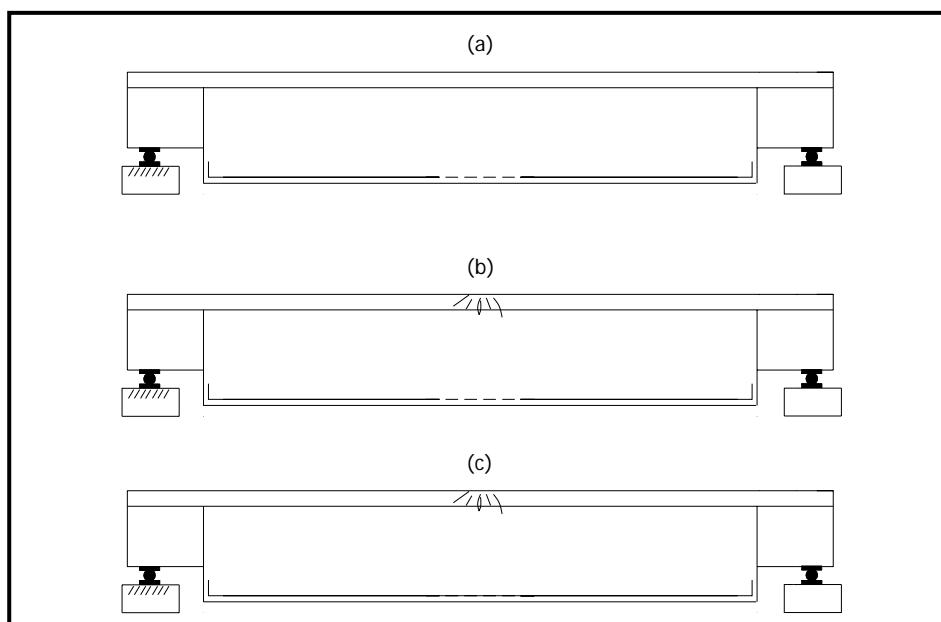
Modos de ruptura à flexão para vigas reforçadas por encamisamento.
